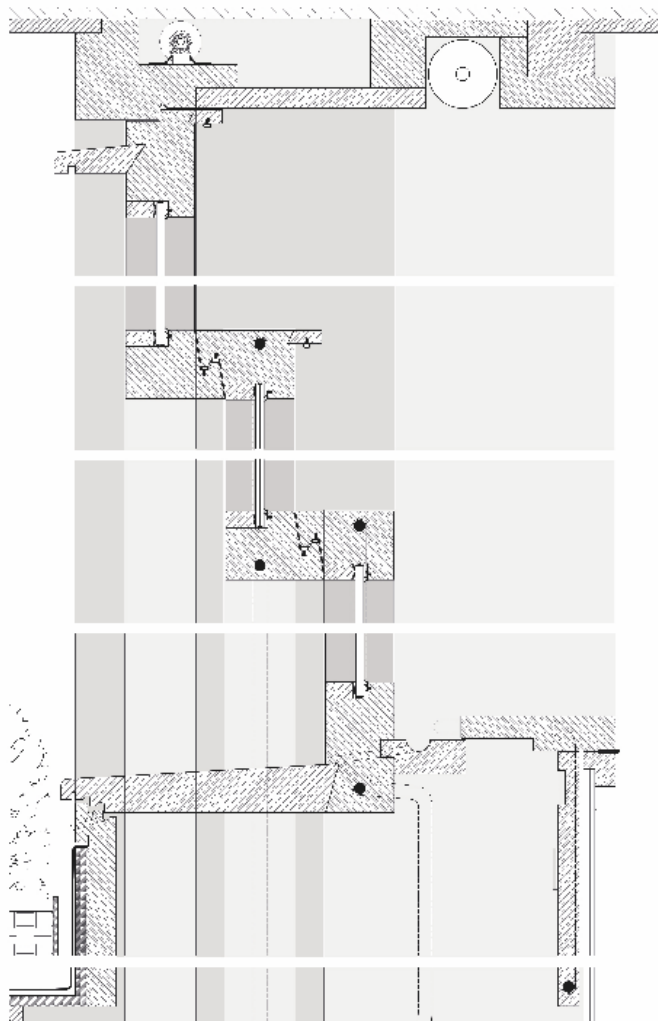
Corte Pormenorizado Caixilho Sul Fechado
